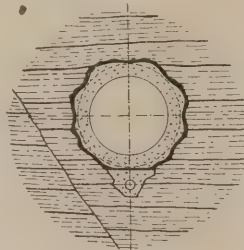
Horizontalquerschnitt durch einen Steigschacht im Ufer des Stausees; durchlässiges Gebirge; bei leerem Schacht äußerer Wasserdruck. Drainage geschlossen.
